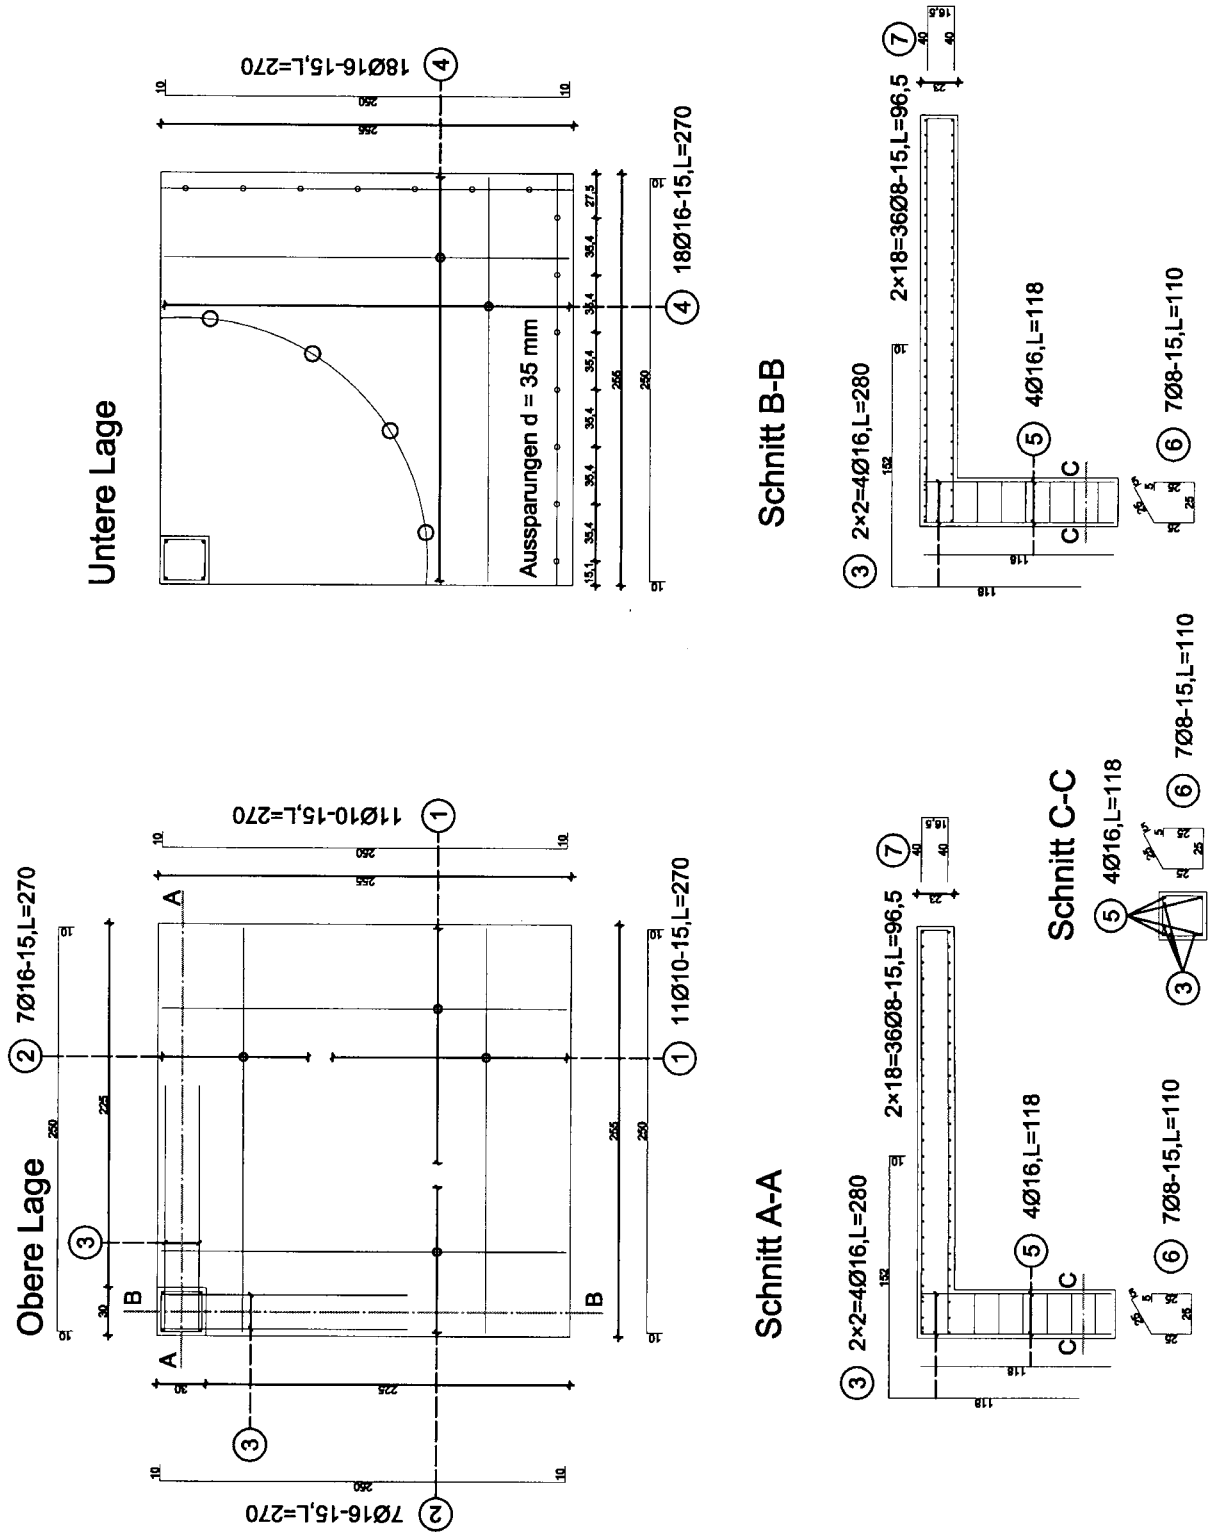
Bewehrungsplan des Durchstanzversuches E1
